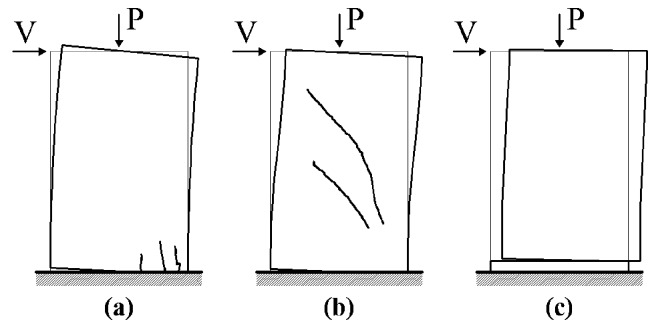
Meccanismi di rottura dei pannelli murari nel piano. In-plane failure modes of masonry piers subject to shear.
